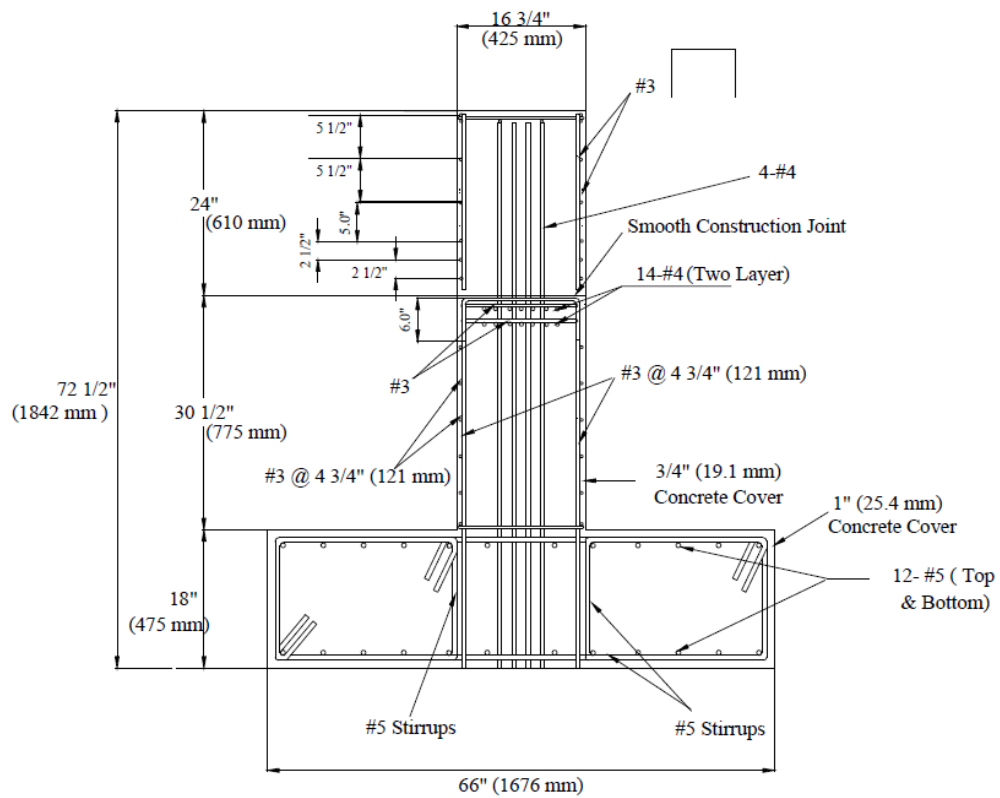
Sección B-B de Refuerzos – Serie 5 Externa (Bozorgzadeh et al., 2007).
